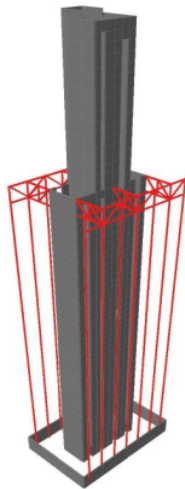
Construcción de muro outrigger (Choi et al., 2012, p.53)
